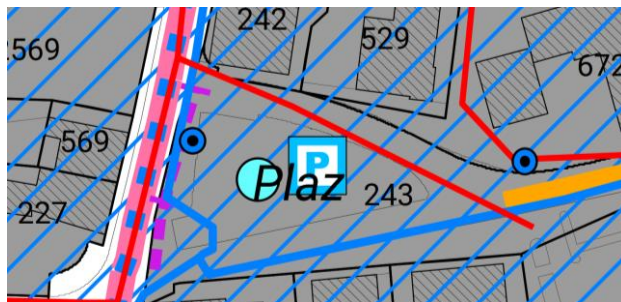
Ausschnitt aus dem revidierten GEP: Geplanter Parkplatz bei den Schrebergärten (Darstellung R+K)
